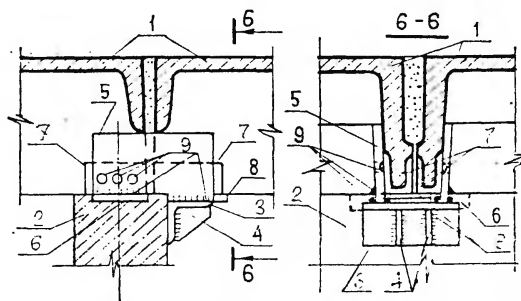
Подведение столиков на сварке с закладными деталями
